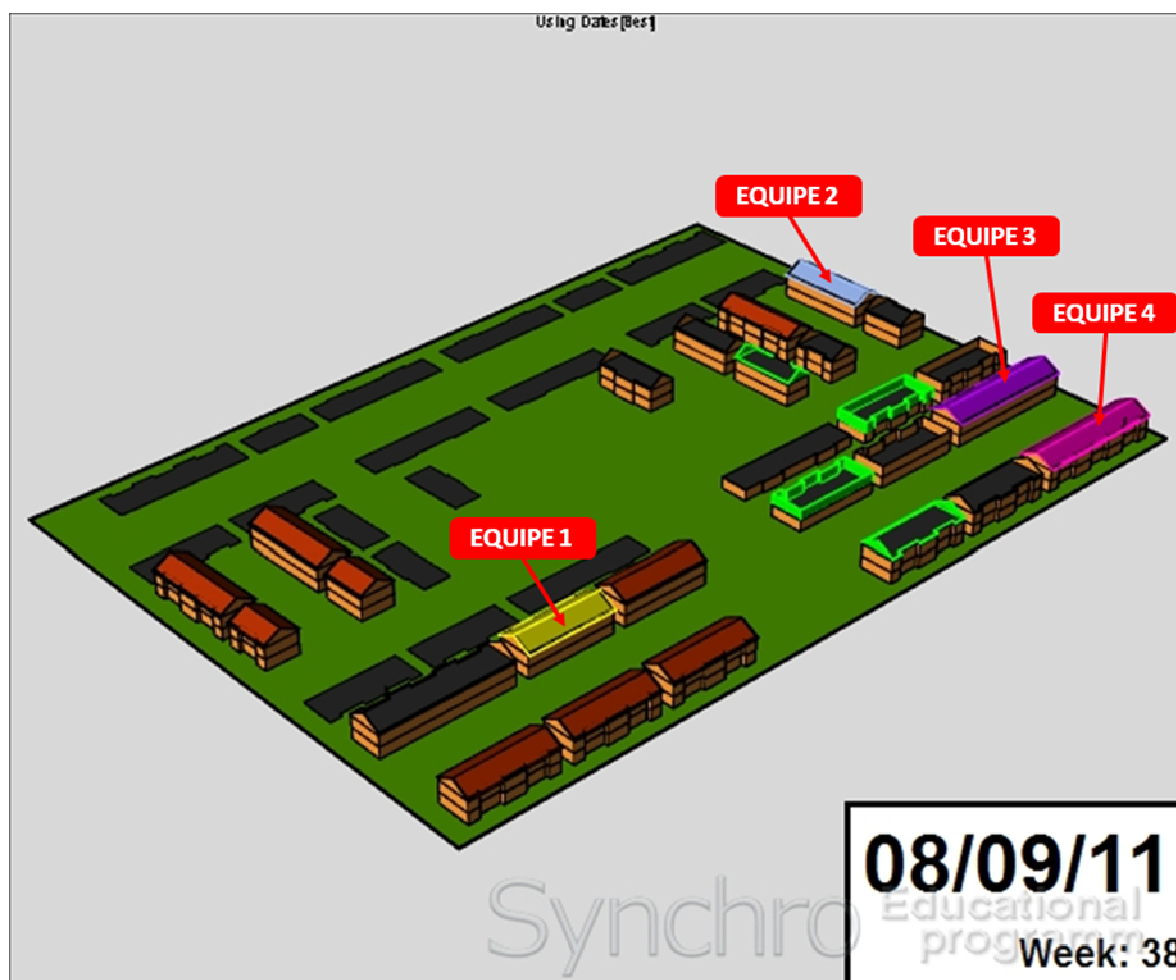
Deslocamento da equipe de execução de telhado do estudo de caso 1
